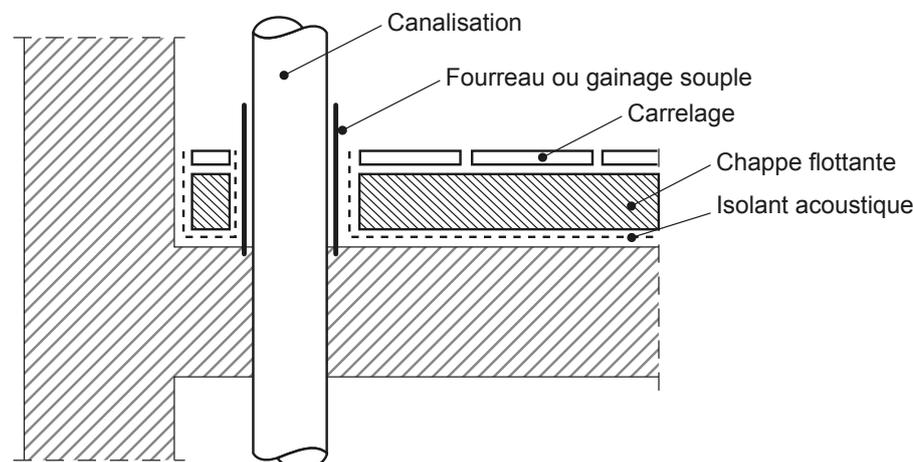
canalisation entourée d'un fourreau ou d'une bande compressible dans la traversée
